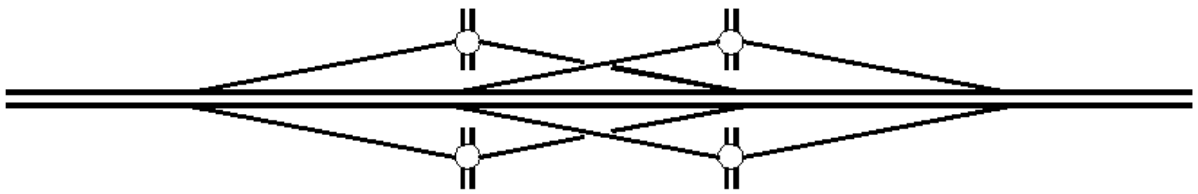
Схема планировочного решения с перекрещивающимися «ромбами»
